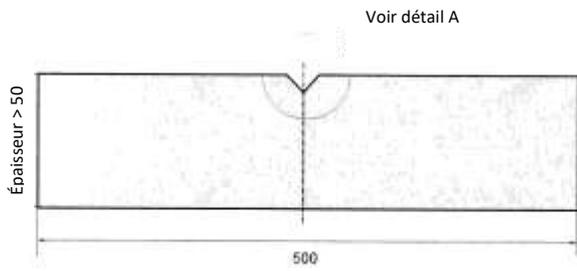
Sto-Panneaux pour Bossage Type III (dimensions en mm)
